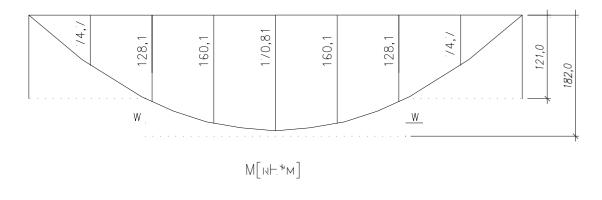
Расчетное сечение ригеля месте обрыва арматуры
